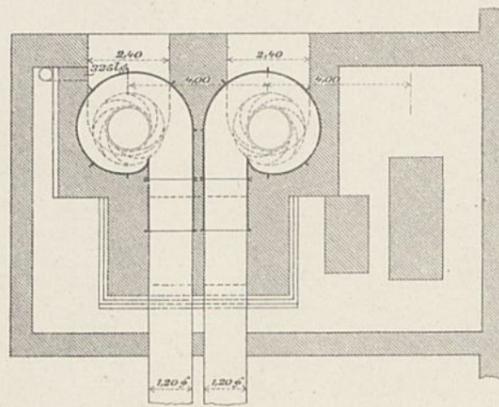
Schnitt durch das Grundmauerwerk des Maschinenhauses und der Pumpen.
